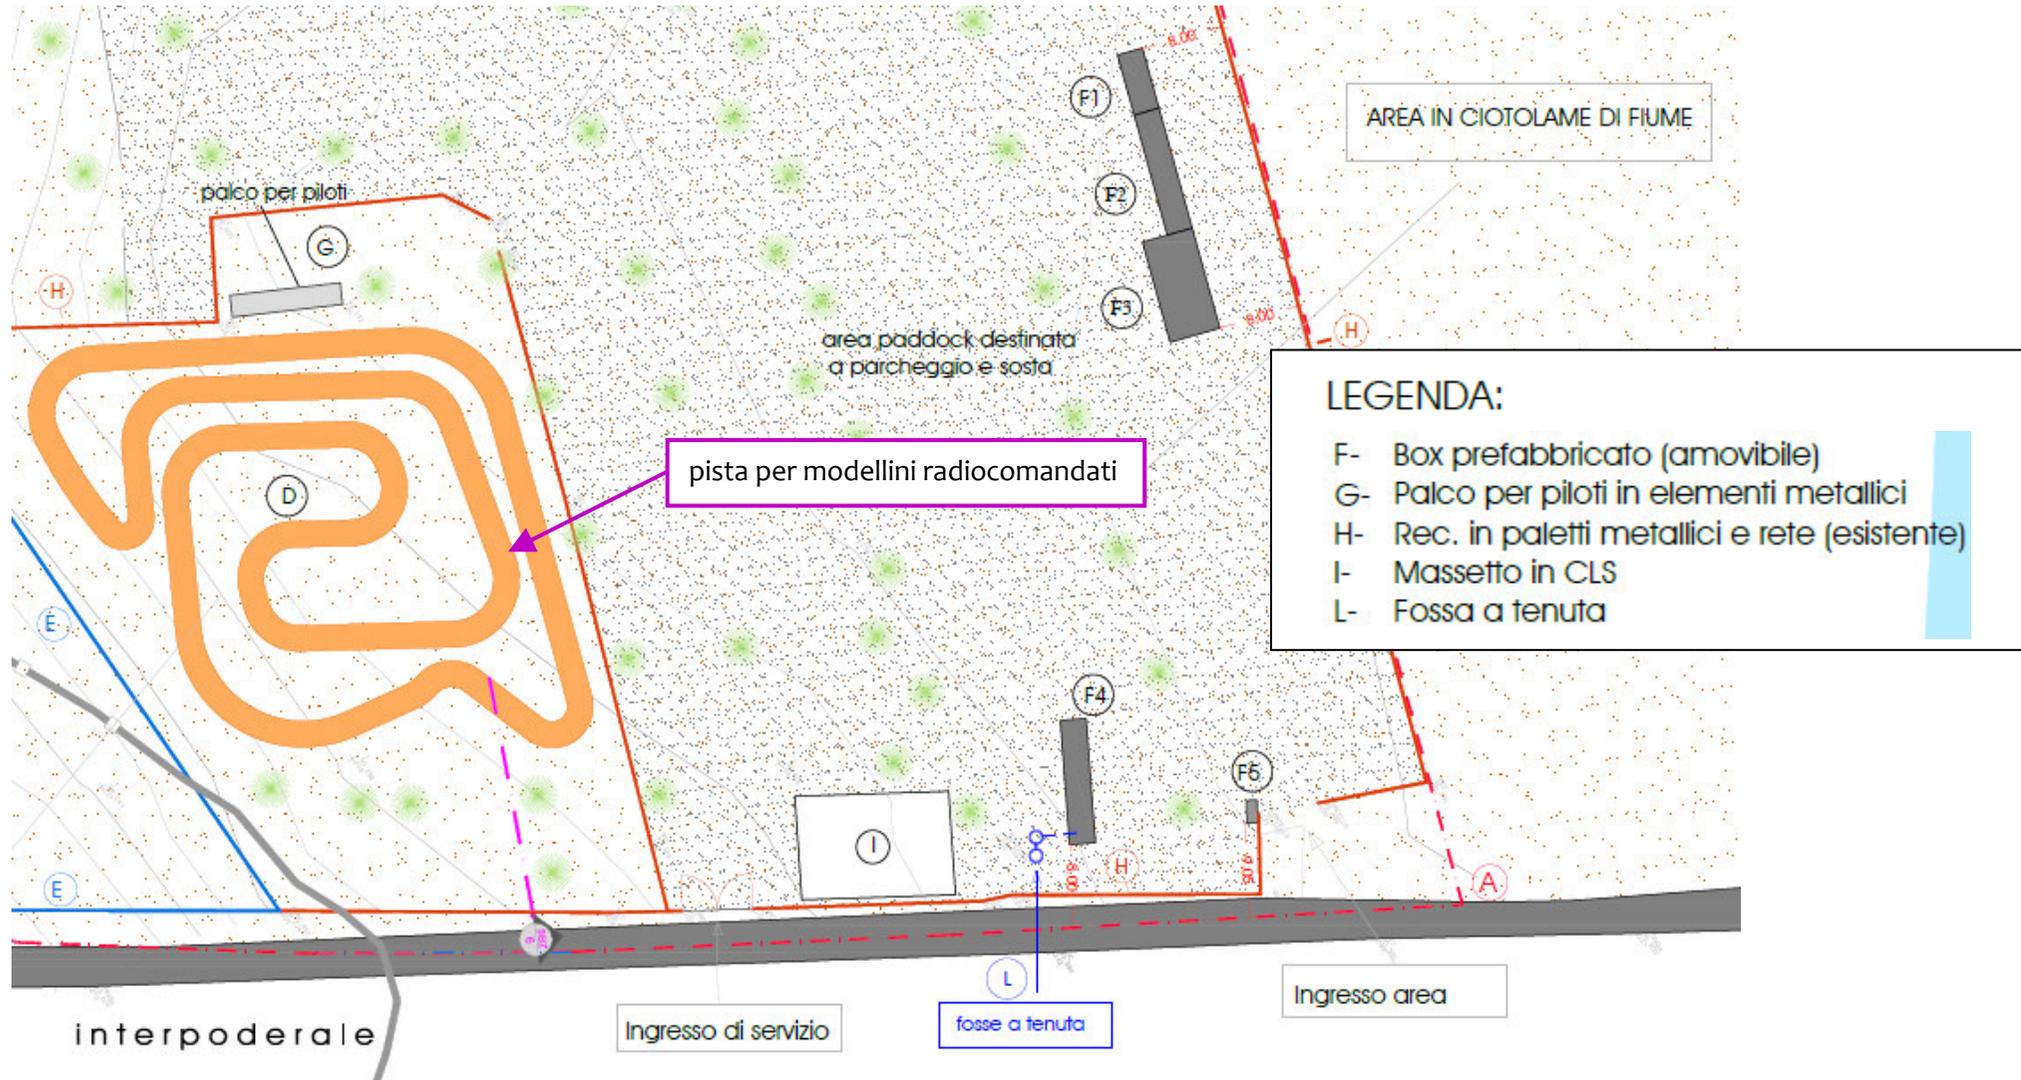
/b: Planimetria generale dell'intervento in progetto - dettaglio servizi
